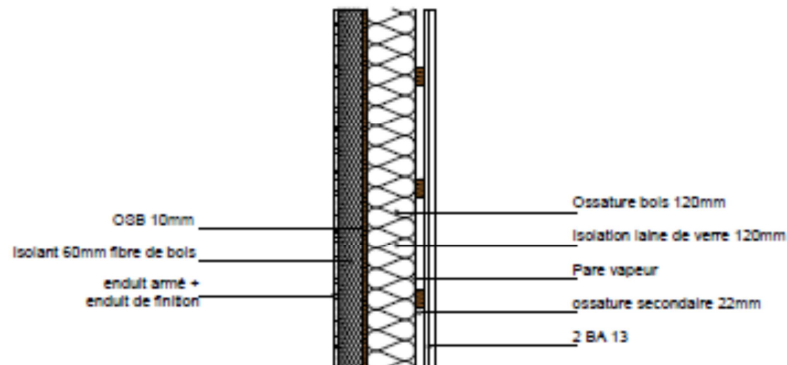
Détail de la façade pour la jonction en T façade – double séparatif.
